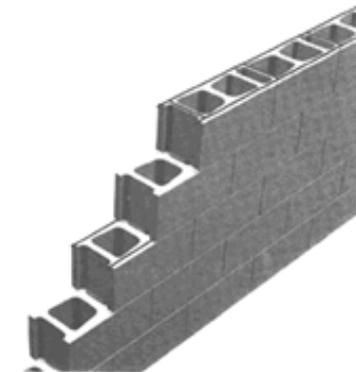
Escalerilla de alambro para refuerzo horizontal, que no impiden la inyección
